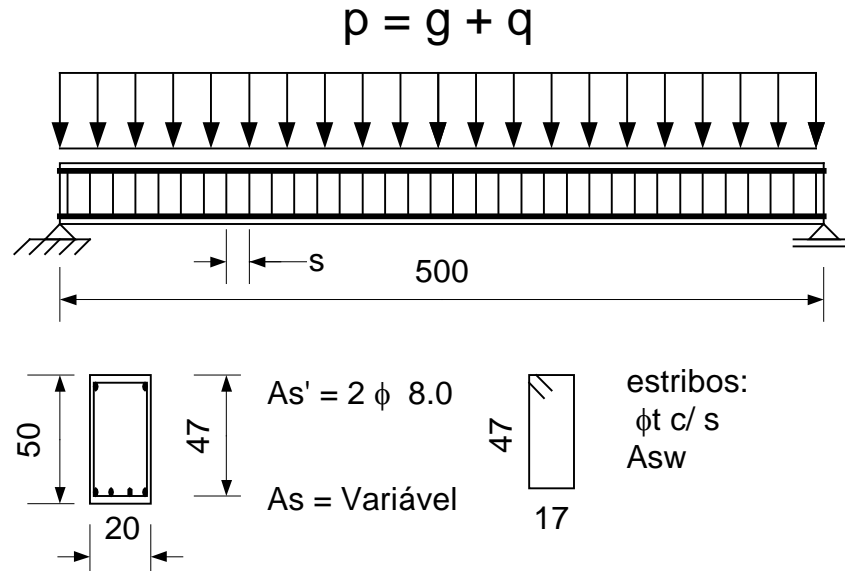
Geometria e carregamento das vigas VA, VB e VC, para testes paramétricos
